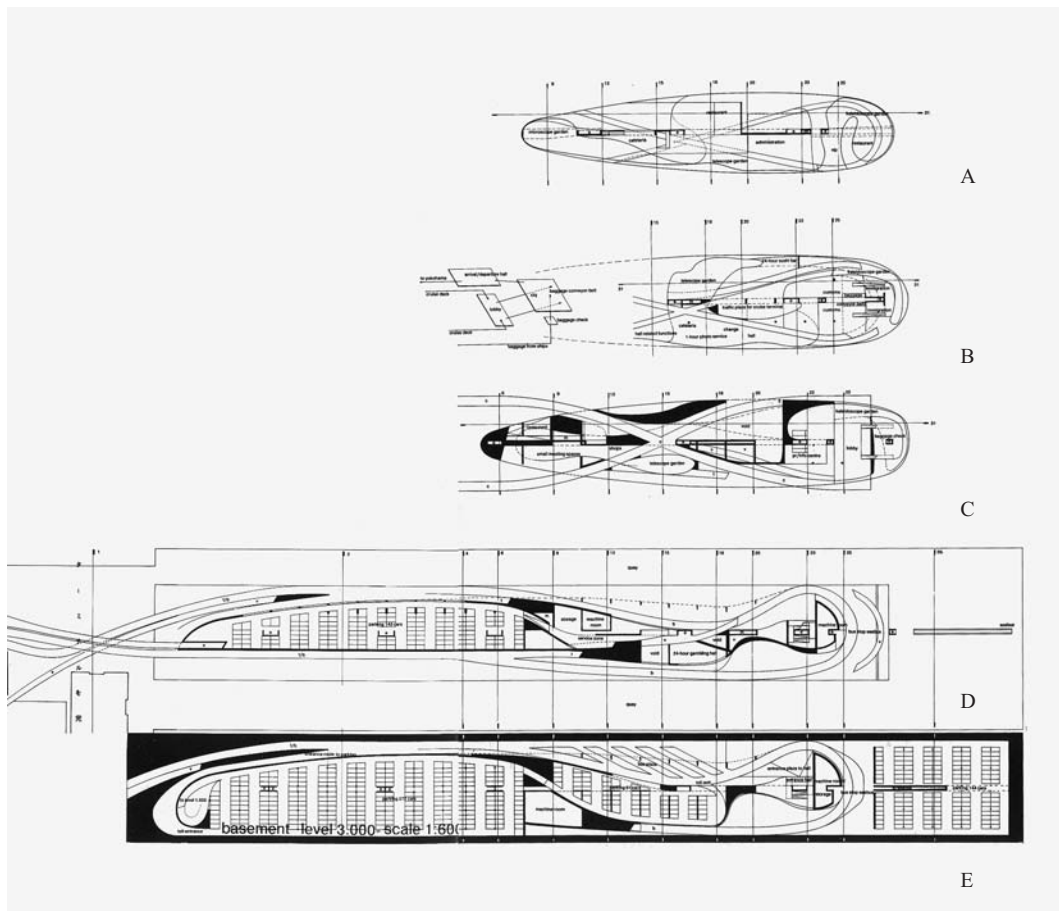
Ben van Berkel, Yokohama International Port Terminal, Japan, Entwurf 1994. Grundrisse: Ebene +23.00 m (A), Funktionsschema Passagiere/Gepäck und Ebene +16.00 m (B), Ebene +9.00 m (C), Pierebene +1.00 m (D), Parkebene -3.00 m (E), Computerzeichnungen.
